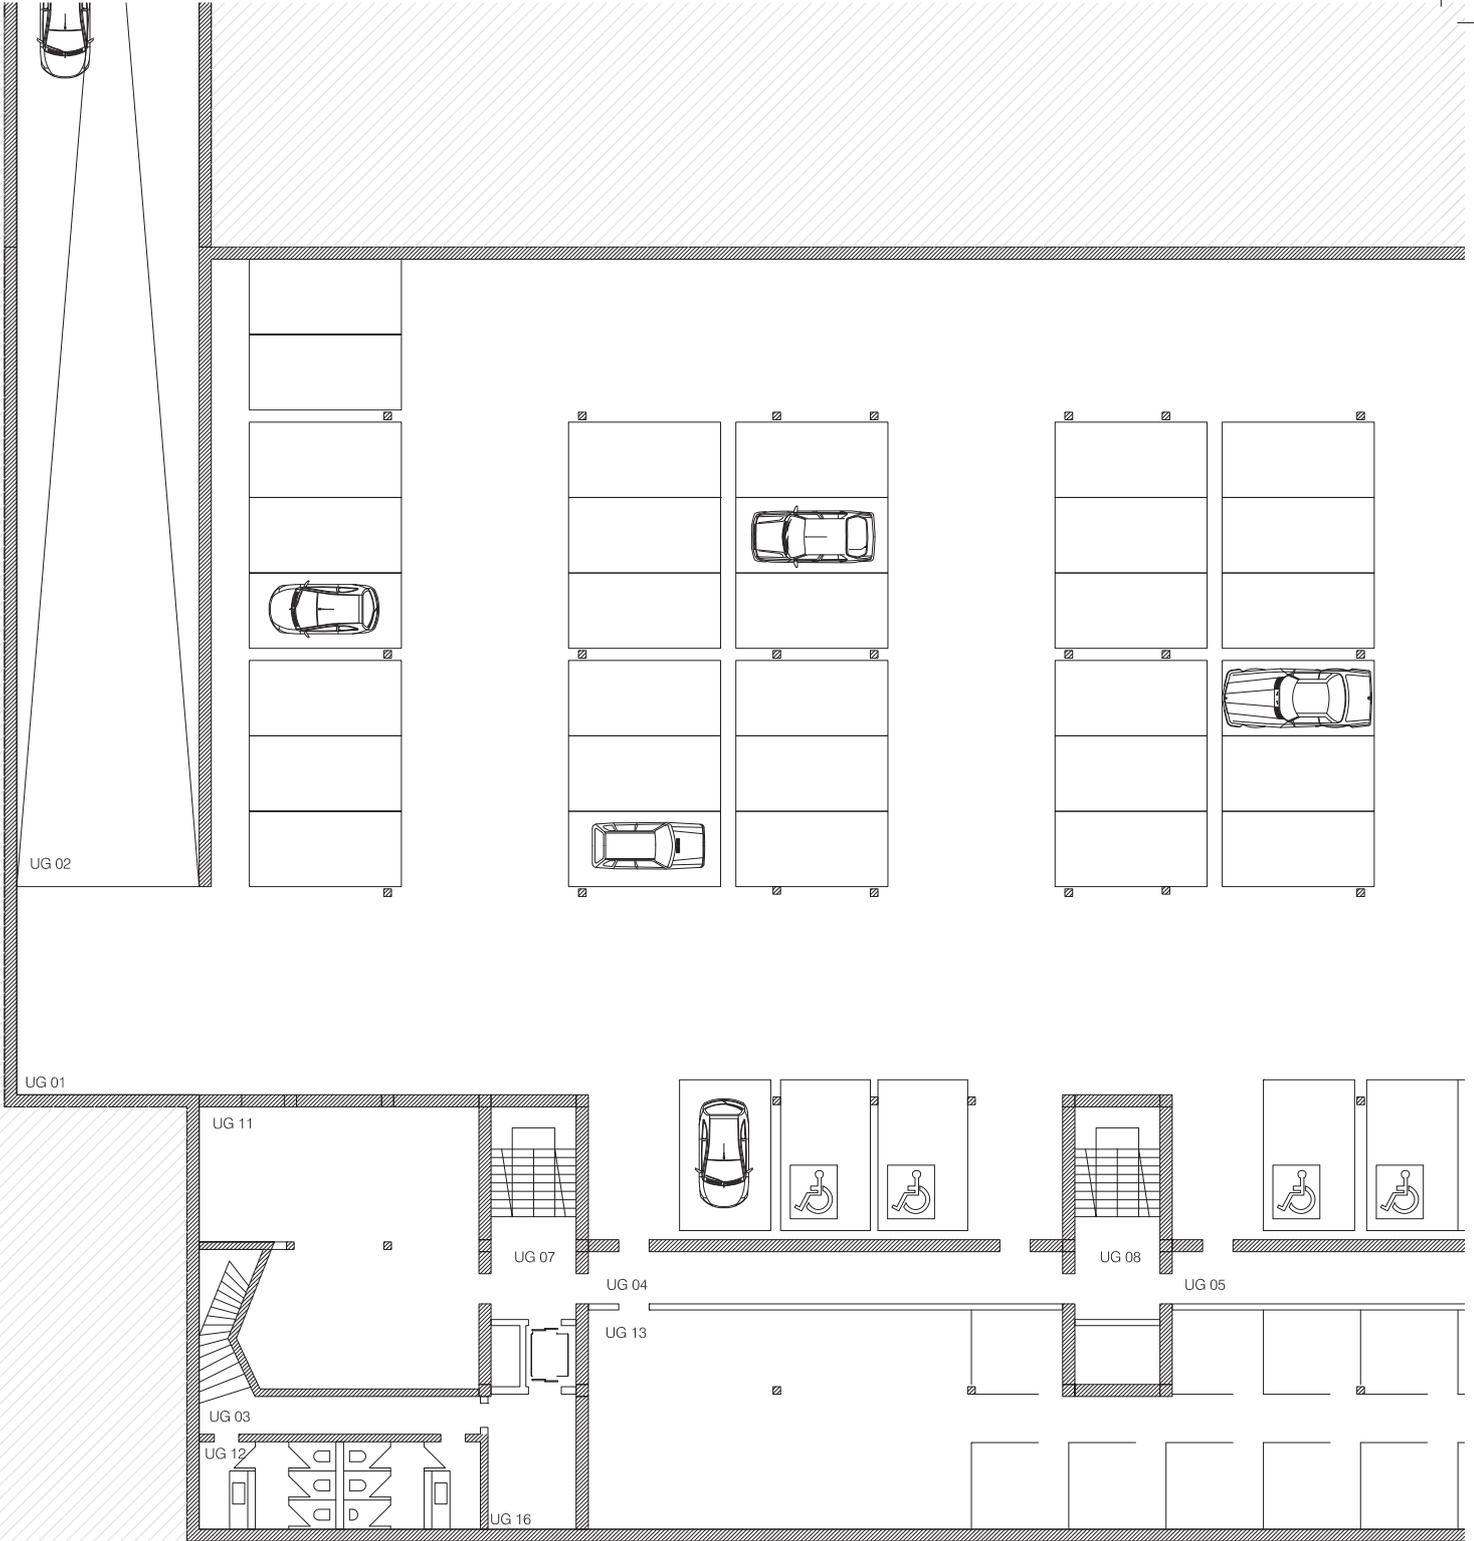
Am heiligen Berg. Eisenstadt Oberberg. Propstei und Stadtpfarre Eisenstadt-Oberberg, Schalling
